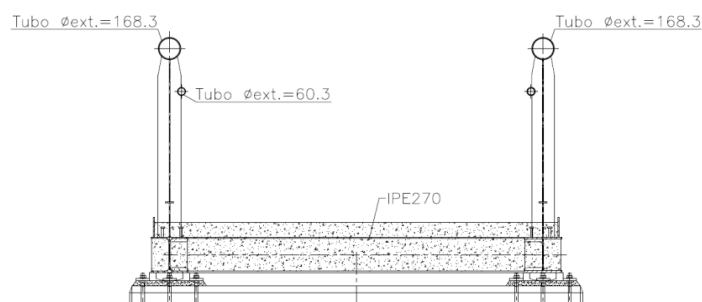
Corte da secção do tabuleiro na zona dos pilares [25].
